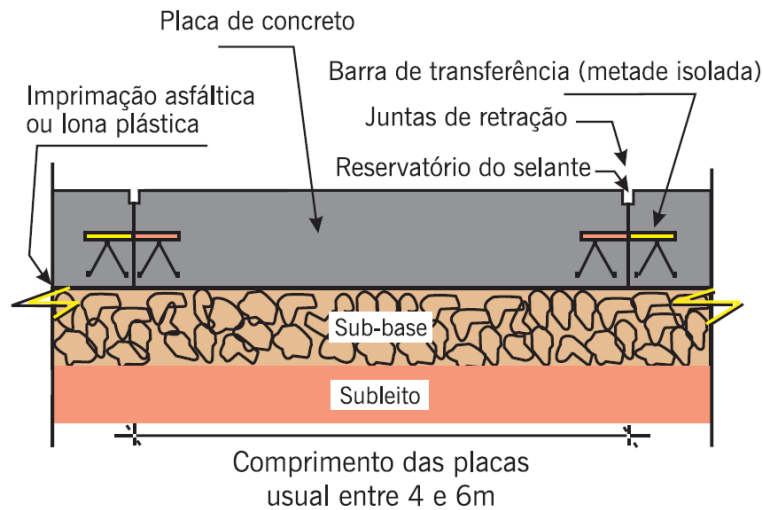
Corte de pavimento rígido (Bernucci et al., 2008)
